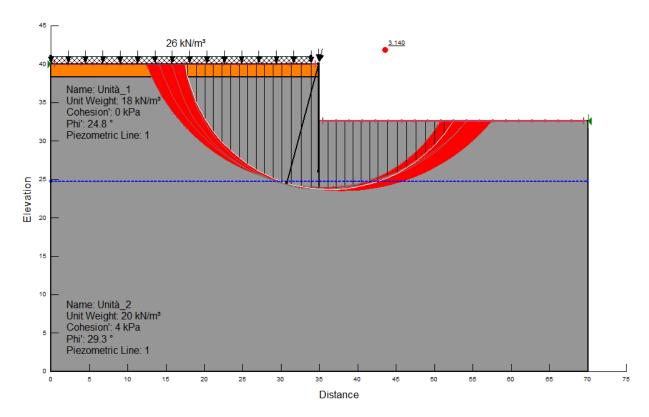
Verifica di stabilità globale della berlinese provvisionale in condizioni statiche
